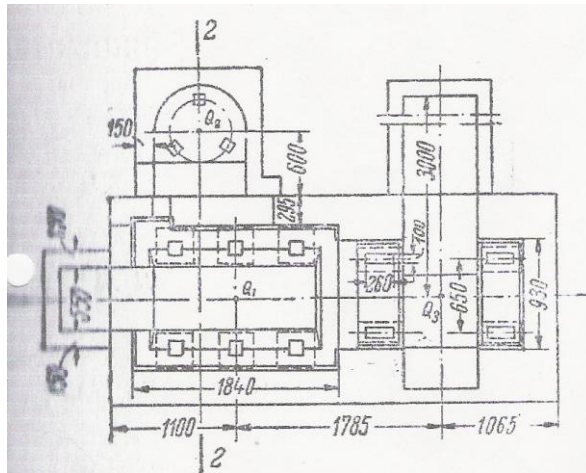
Габаритные размеры верхней части фундамента под вертикальный компрессор (к примерам 1 и 2)
